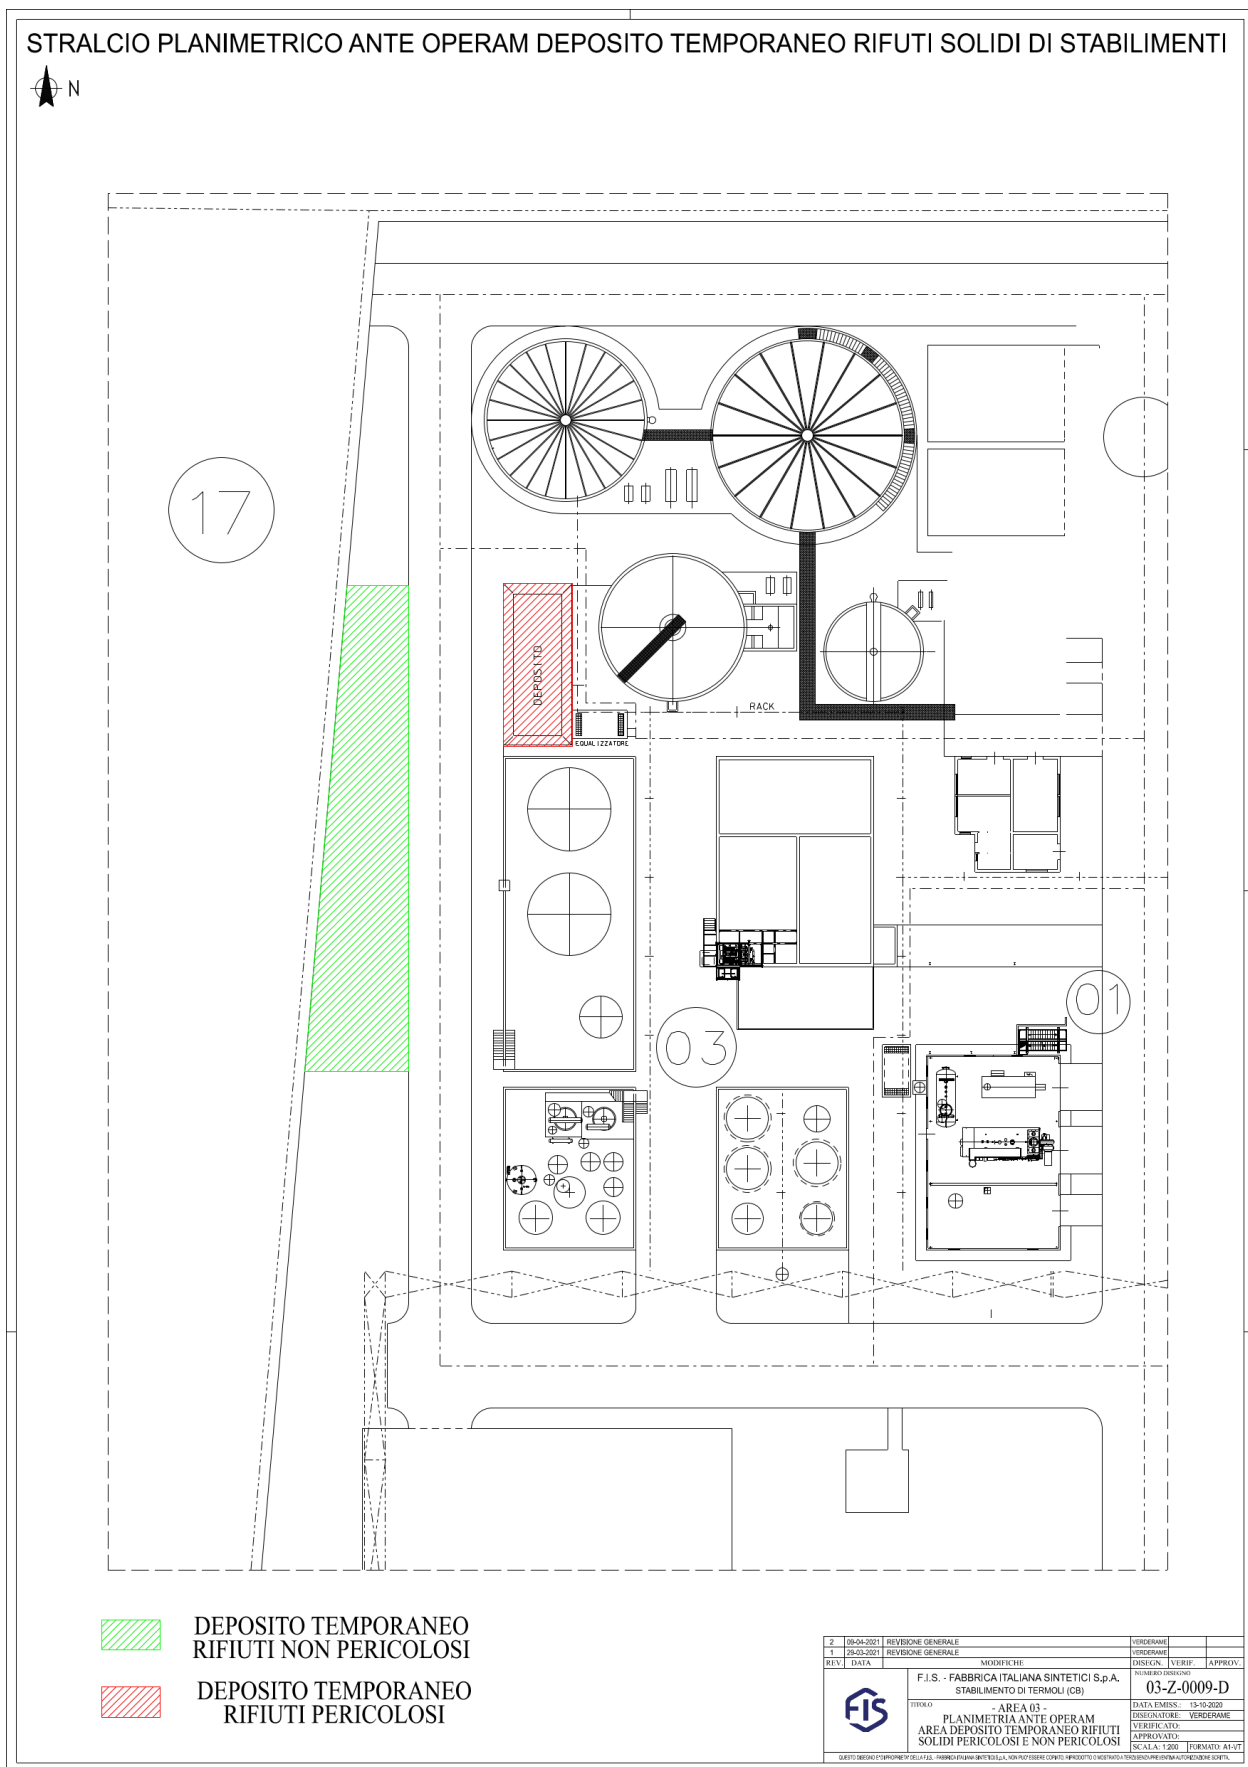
planimetria generale di stabilimento con indicazione delle zone di svolgimento del deposito temporaneo rifiuti: assetto "ante operam"
